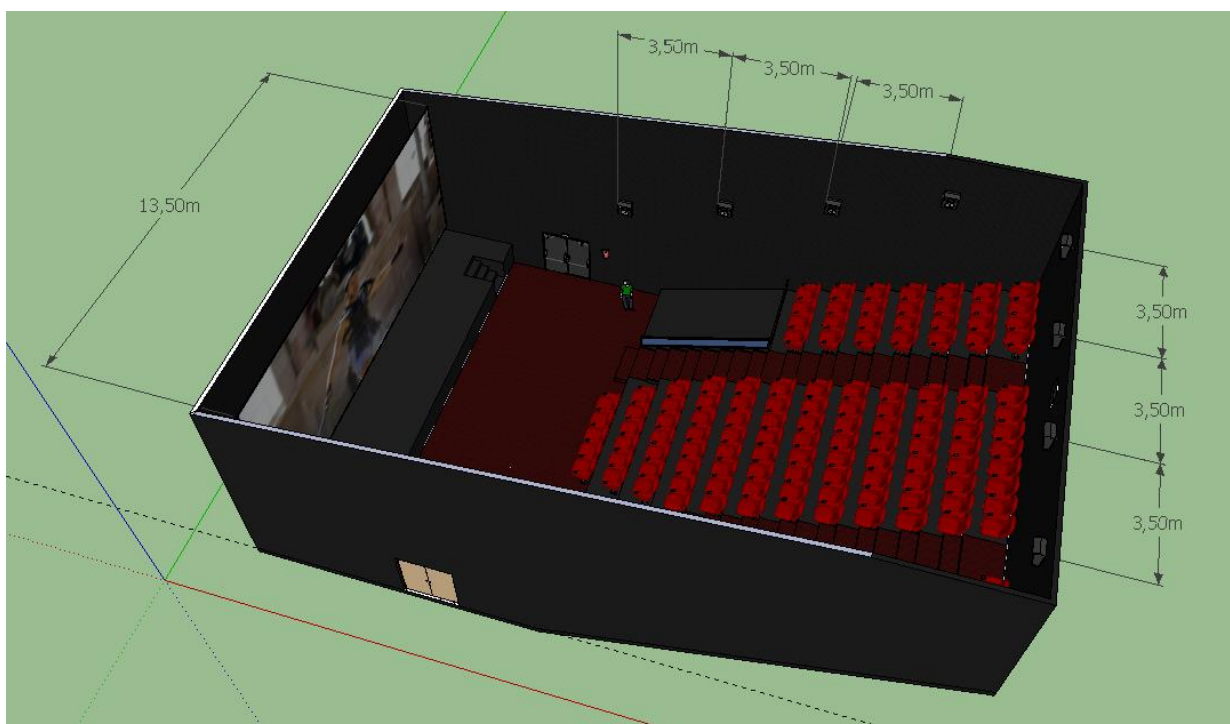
Colocación la pantalla y de los altavoces de surround.
